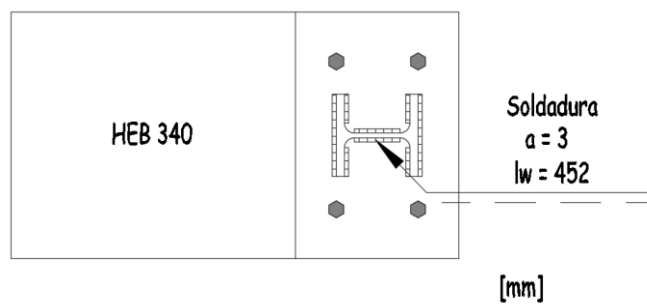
Chapa de ligação com cordão de soldadura
